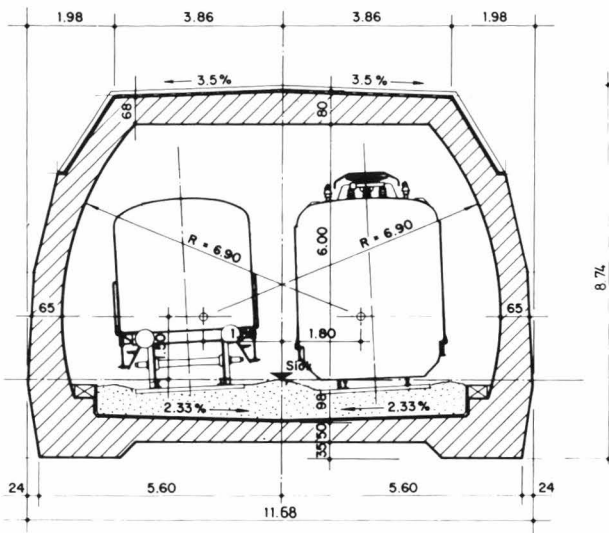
Normalquerschnitt der Brücke – Coupe en travers normale du pont – Normal bridge cross section
